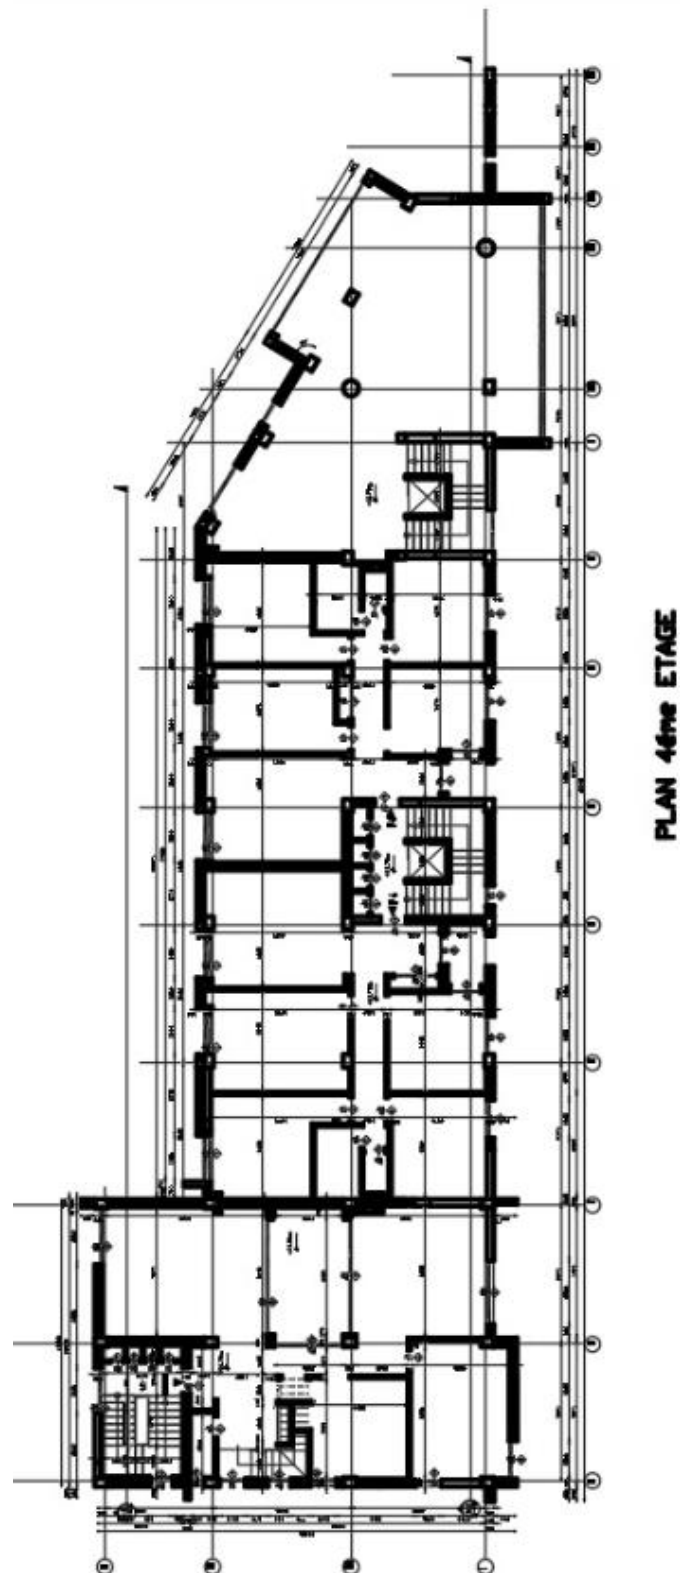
Plan architecture niveau 4^{ème} étage.
